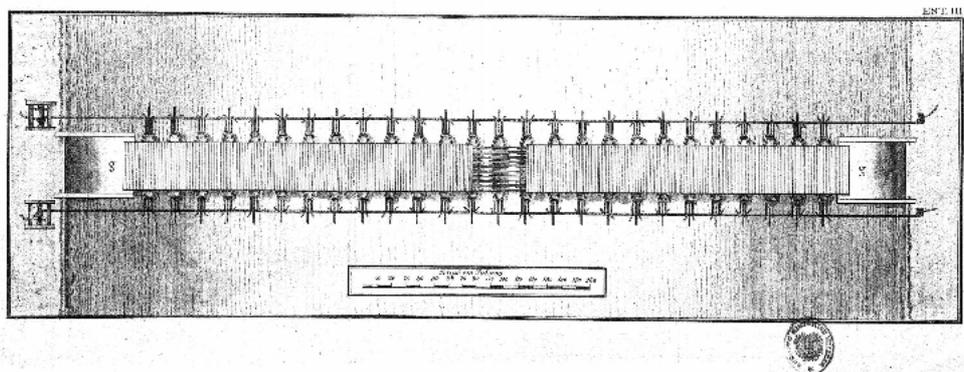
Estudo de Eusébio de Sousa Soares sobre a construção de um canal para protecção de Castro Marim (Vista de uma ponte de barcas).
